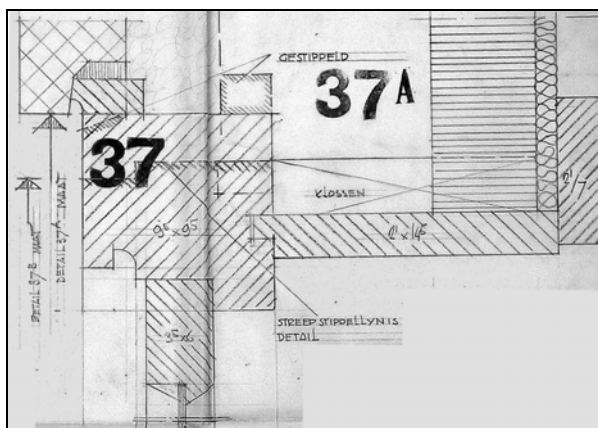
en 79: de verticale doorsnede over een kozijn in de voorgevel met beglazing en een doorsnede over het ventilatierooster. De houten dorpels worden beëindigd met een betonnen latei. NAI archief MELK, NM 26-2.
